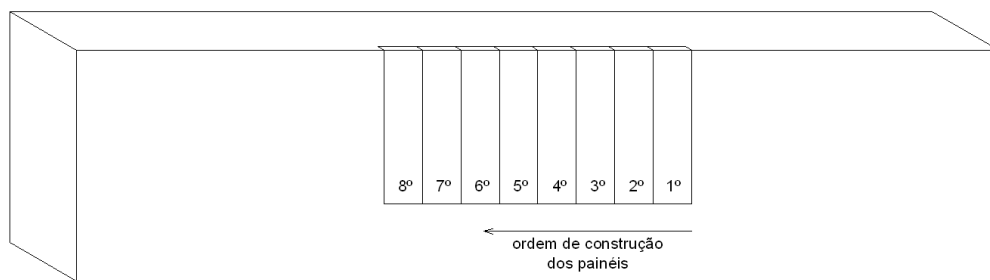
Ordem de instalação dos painéis da parede moldada.
